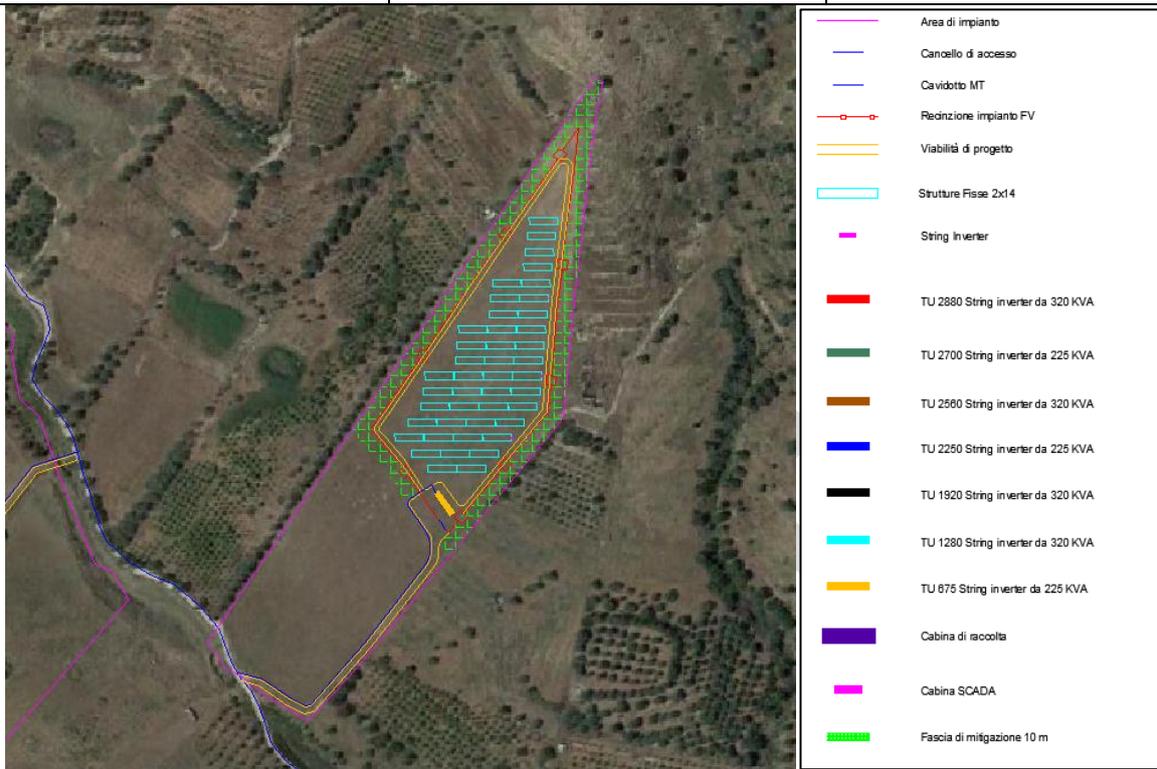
Sovrapposizione su ortofoto del layout di impianto – Lotto 7
